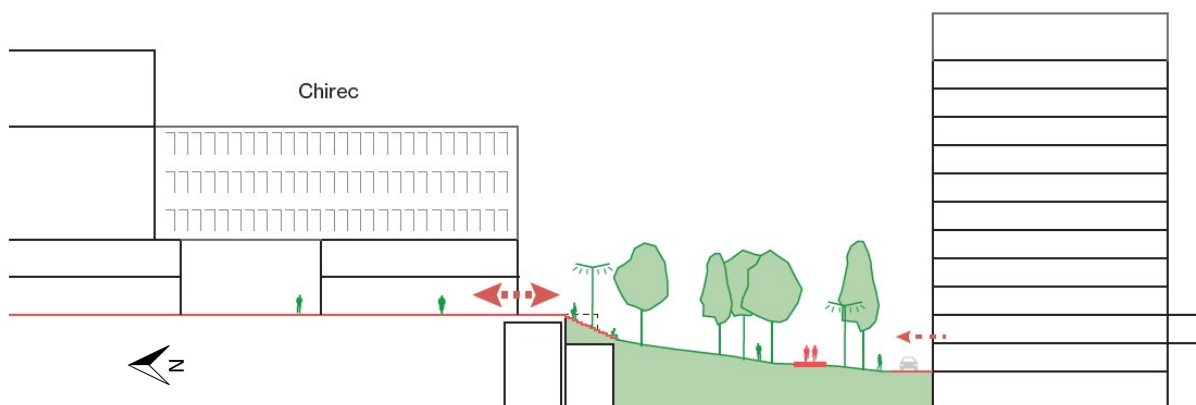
Profil du Parkway du site Triangle (ORG², 2018)
